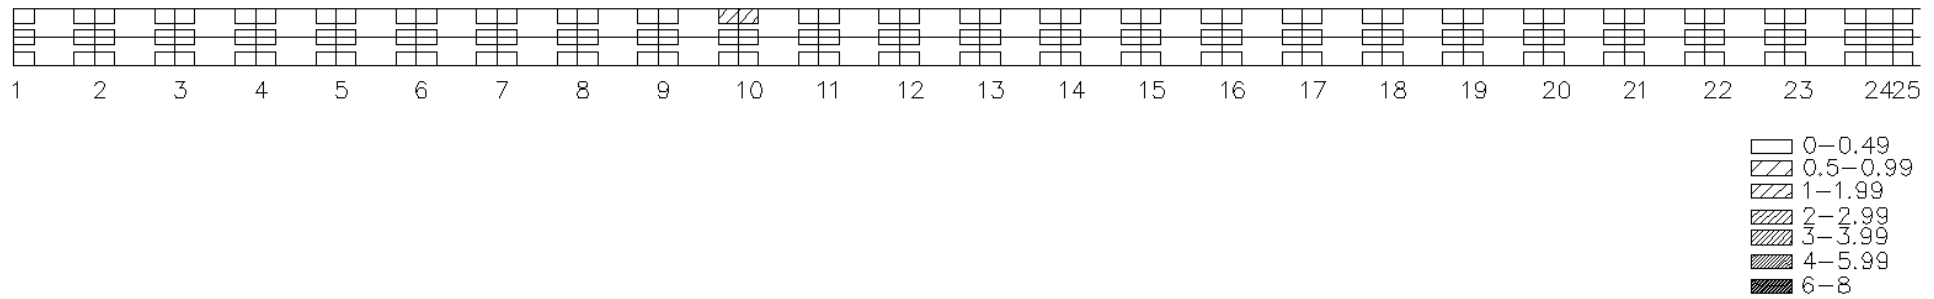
Frästiefen bei Tangenten und quadratischen Parabeln und Verfahrensplan Typ V, Grundriss, Stationen 1-25
